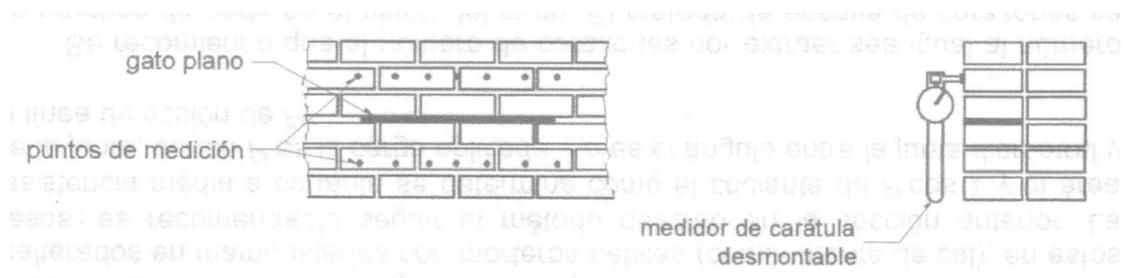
Dispositivo de prueba para la determinación in situ del estado de esfuerzos de compresión existente dentro de la mampostería.
